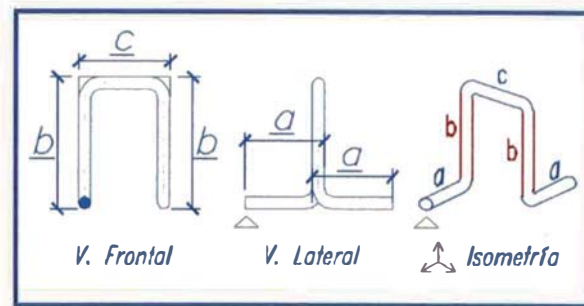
Modelo tridimensional de las silletas según lista de despiece de Corporación Aceros Arequipa. Fuente Corporación AASA.
